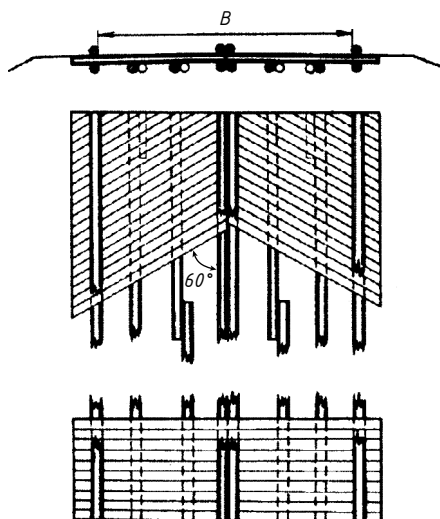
Конструкция покрытия со сплошным бревенчатым настилом (косым и прямым)
